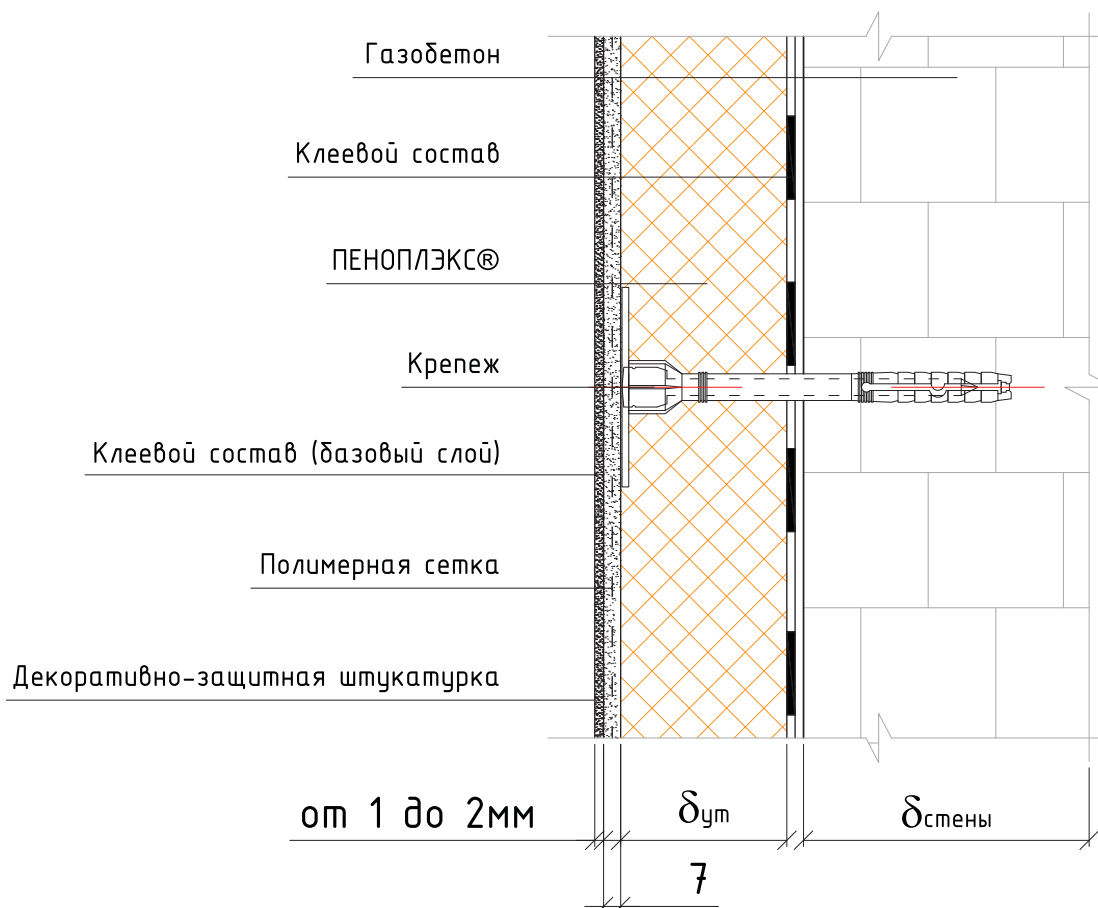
Схема конструкции стены первого или цокольного этажа №3
